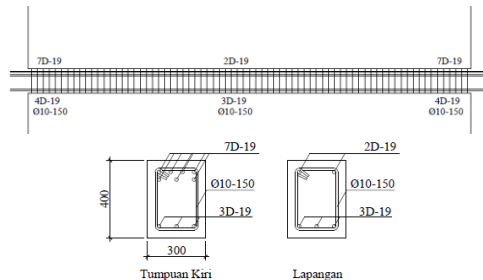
Detail tulangan untuk penyaluran kait standar
